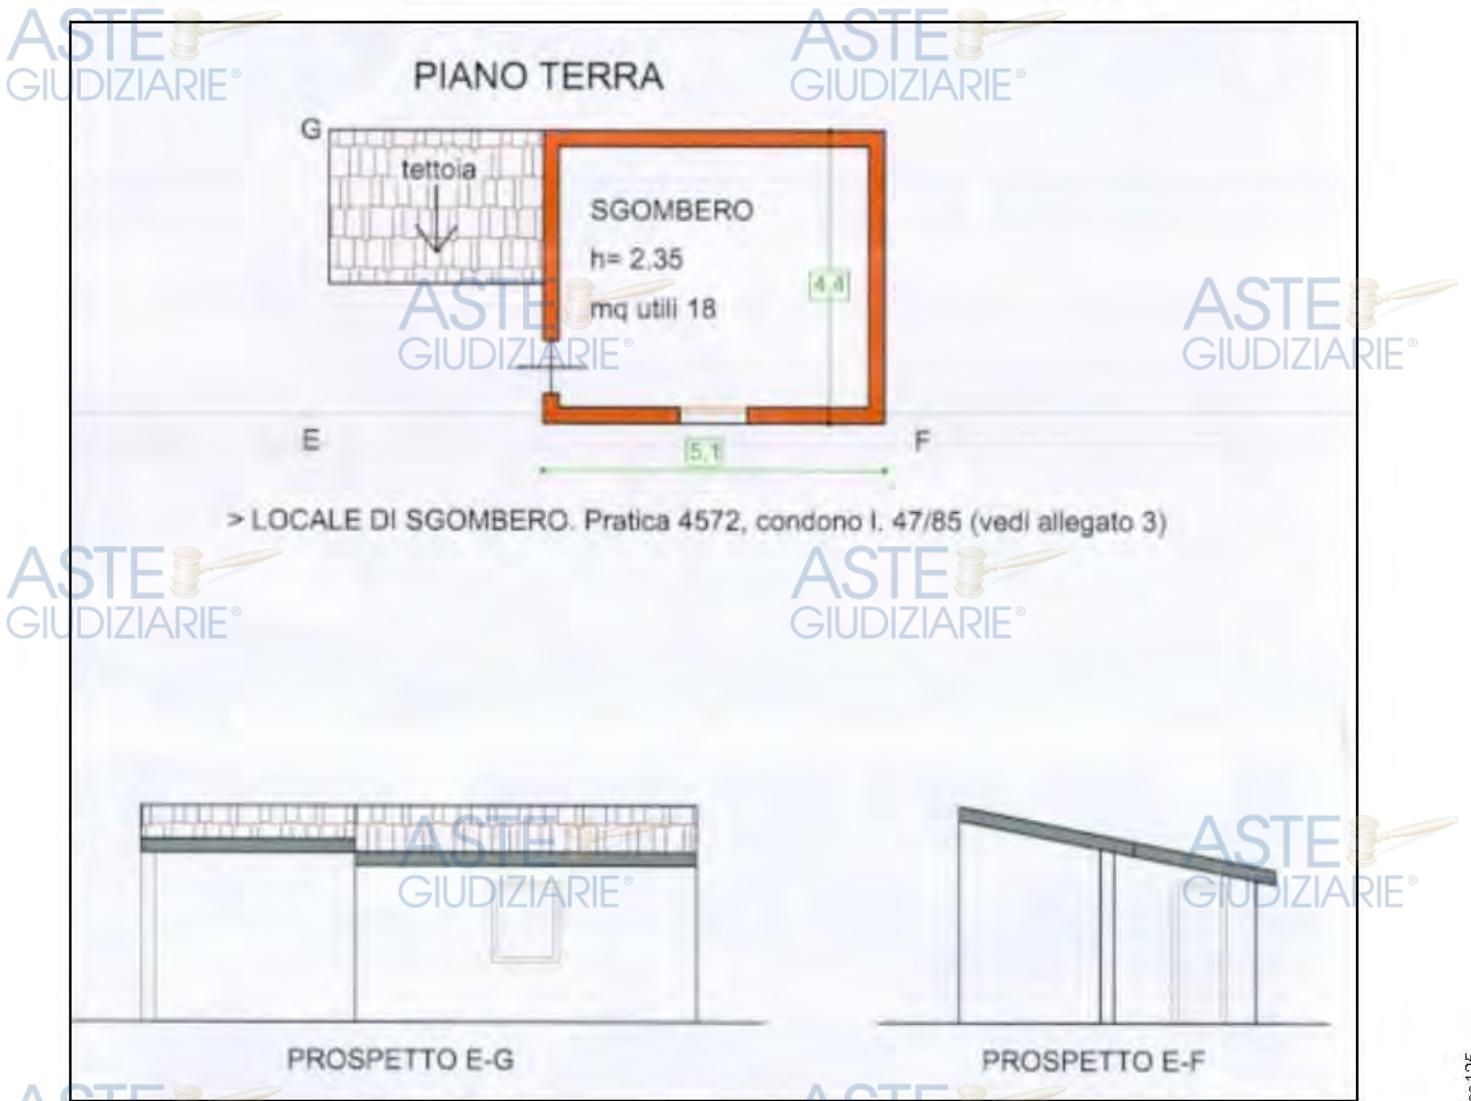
Subalterno 5 – Piano Terra – Planimetria stato di progetto – Concessione in Sanatoria n. 4572
